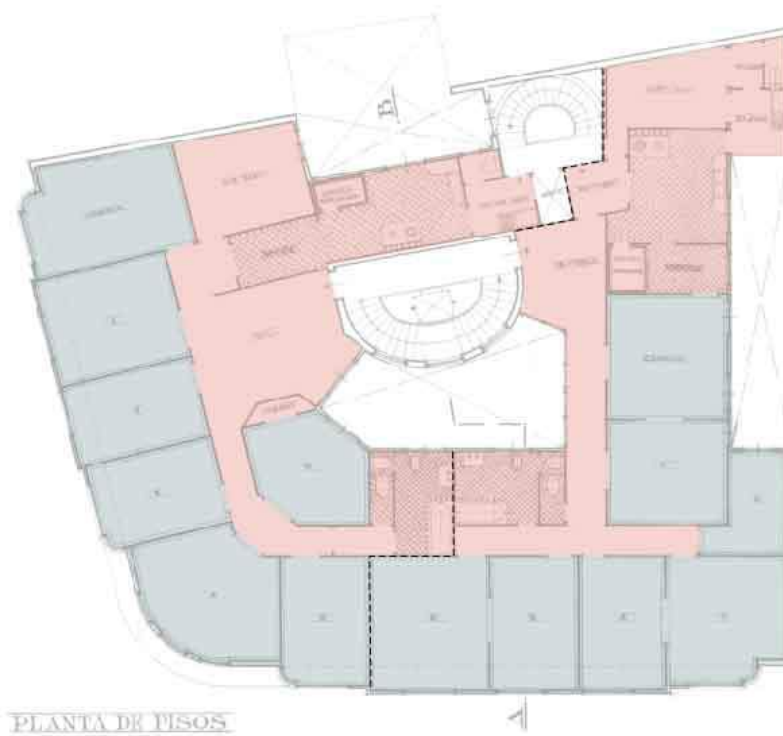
Edificio Legorburo. Planta de pisos. Proyecto original. Tratamiento digital: Javier Cuartero Colmenero.
